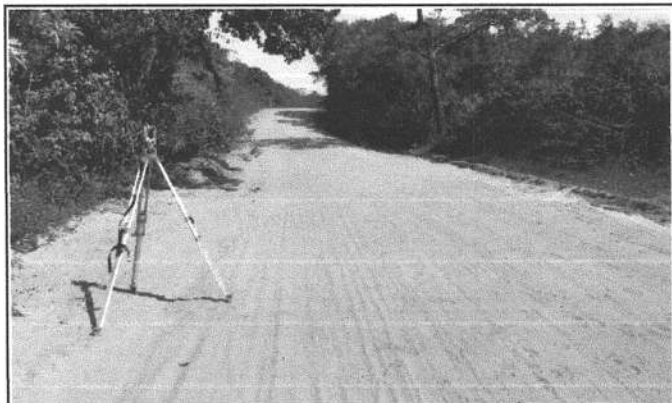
LOCAL DA CONSTRUÇÃO - BUEIRO
